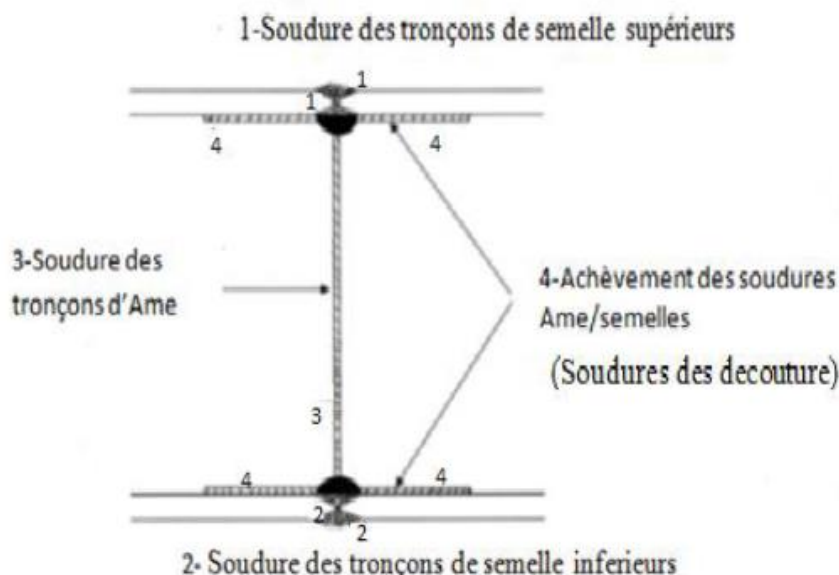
Phasage de mise en œuvre des soudures d'assemblage bout à bout des poutres d'un bipoutre.
